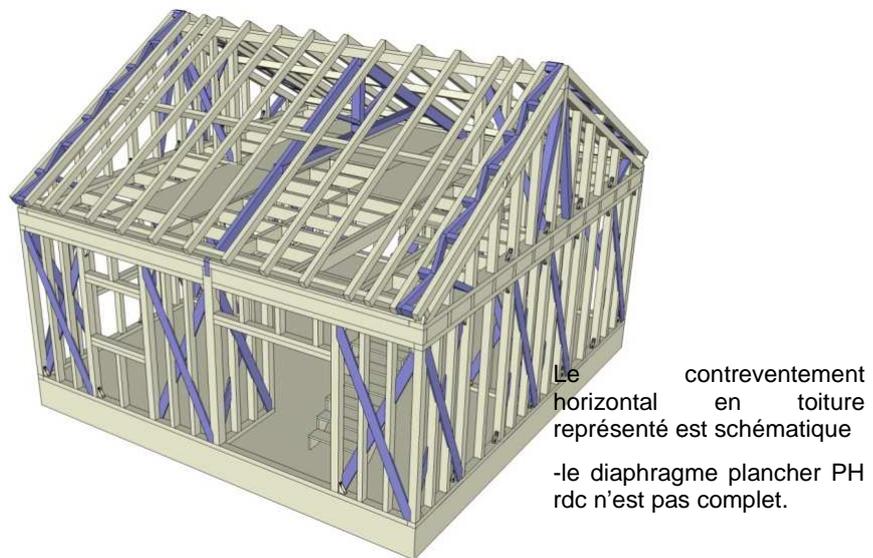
Exemple de maison à simple rez-de-chaussée avec plancher combles total et toiture à 2 versants
